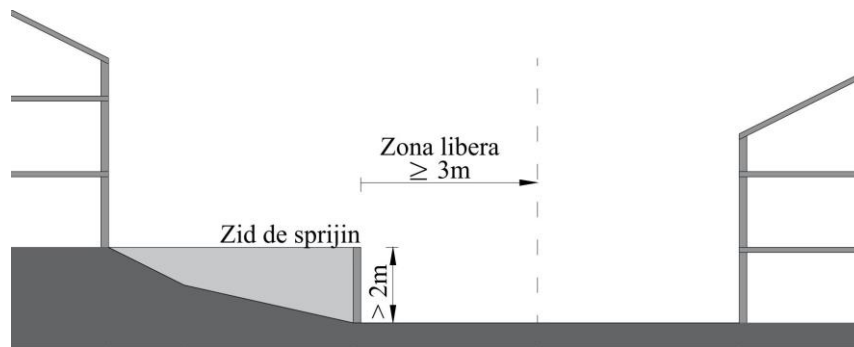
Perete de sprijin cu relevanță pentru zona liberă
